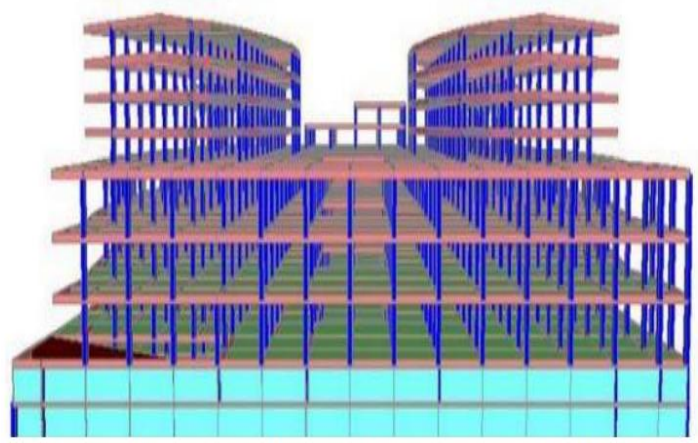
la structure du centre commercial de Bab Ezzouar.
